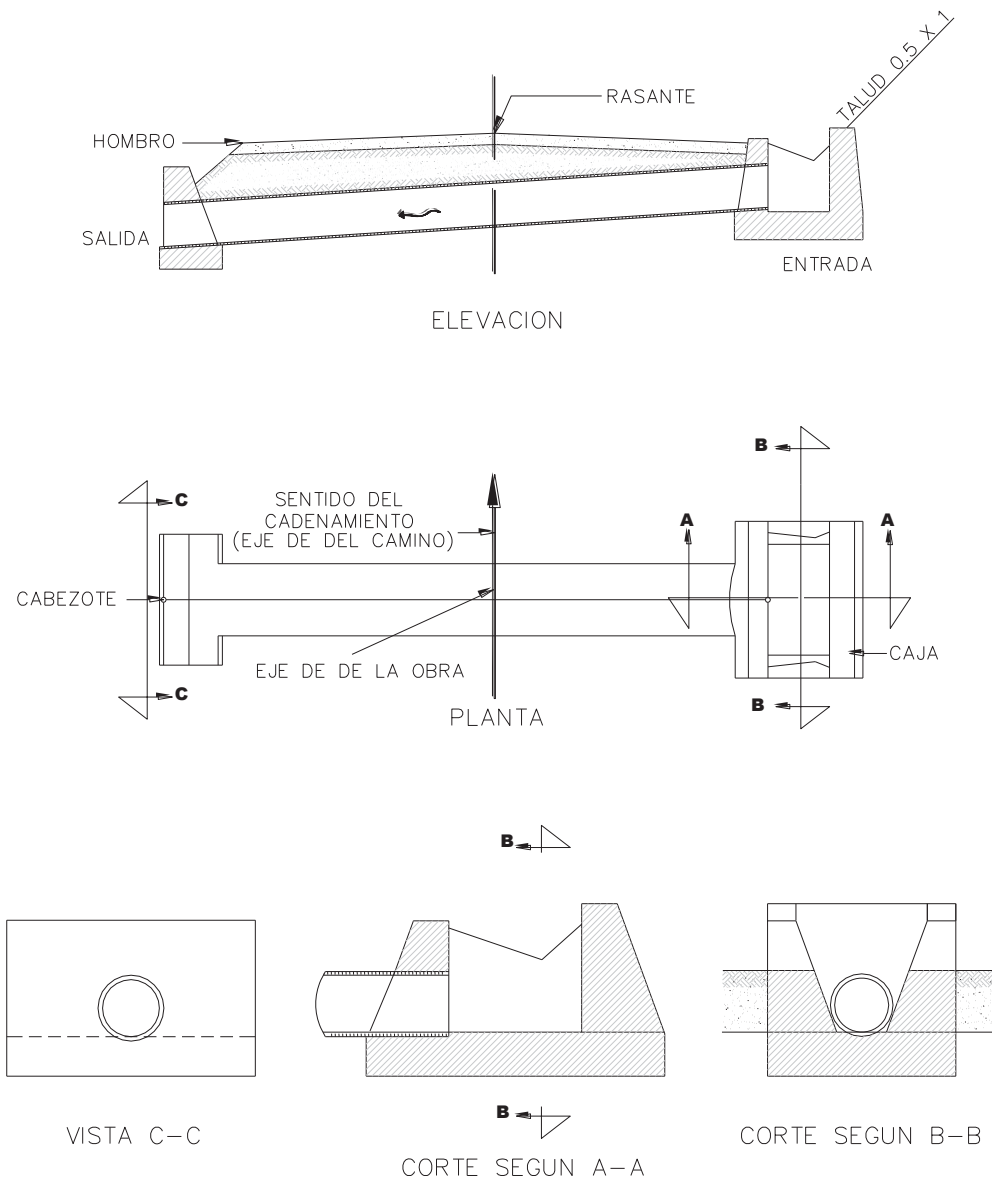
Alcantarilla de tubo con caja en la entrada.
